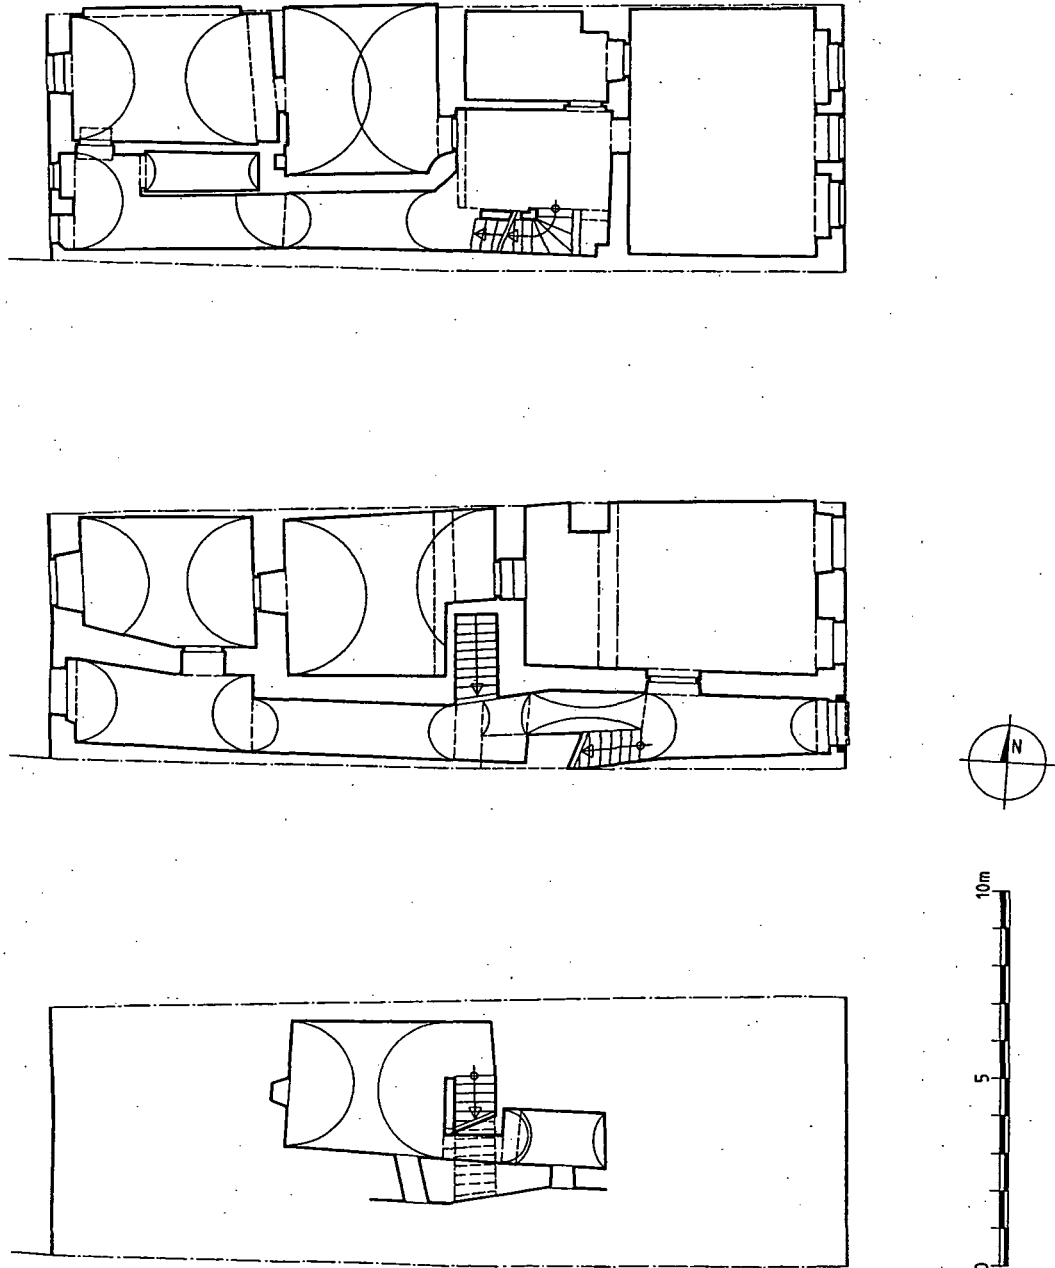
Stadtplatz 30 – Grundrisse Keller, Erdgeschoss, Obergeschoss (1:200).
